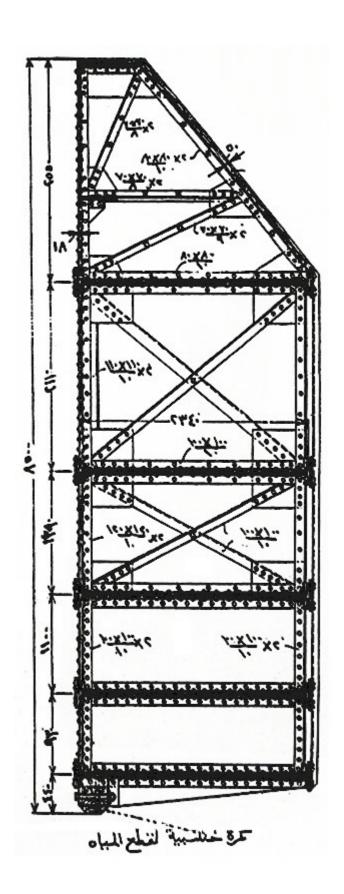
تدعيم البوابات المستوية بكمرات أفقية لوحيه ذات عزم قصور ذاتى متغير
